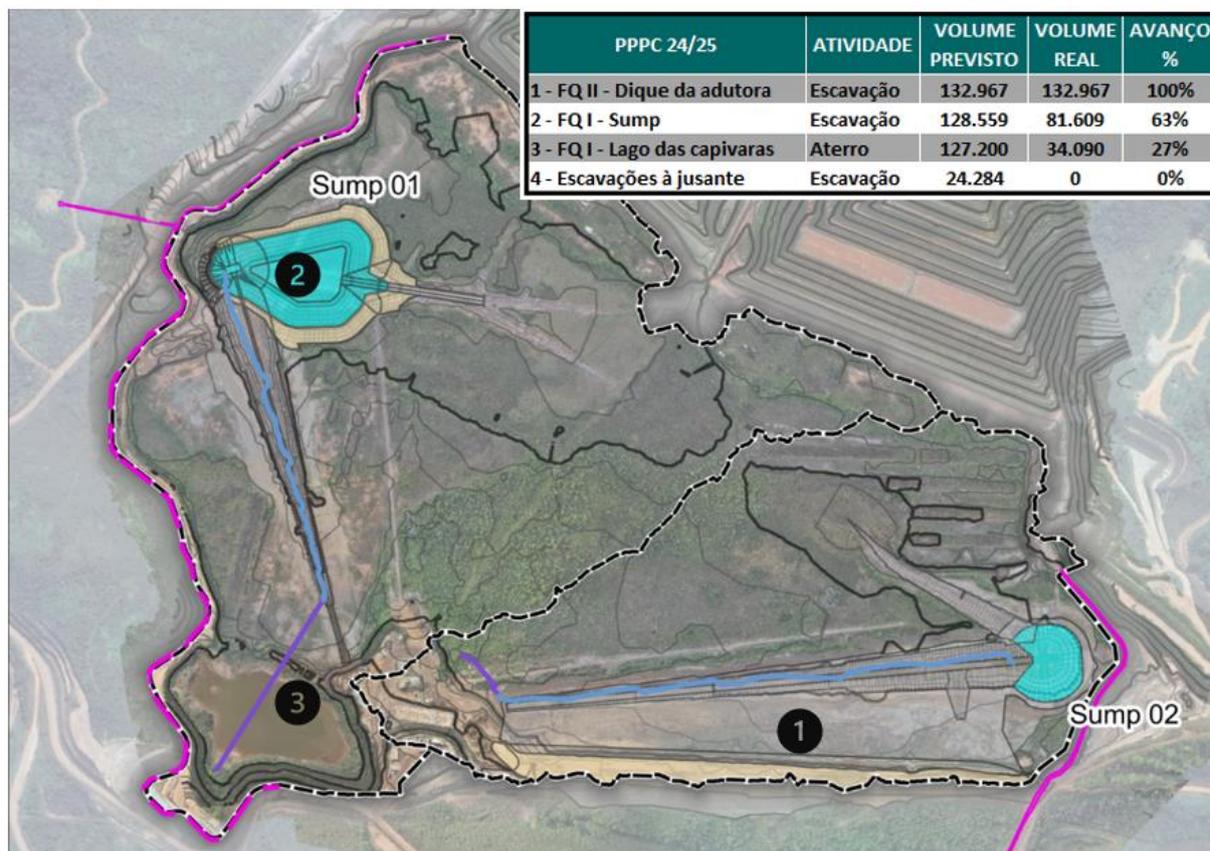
Planta geral do teste piloto e plano de chuvas de Forquilha I – Implantação concluída (Outubro/24).
